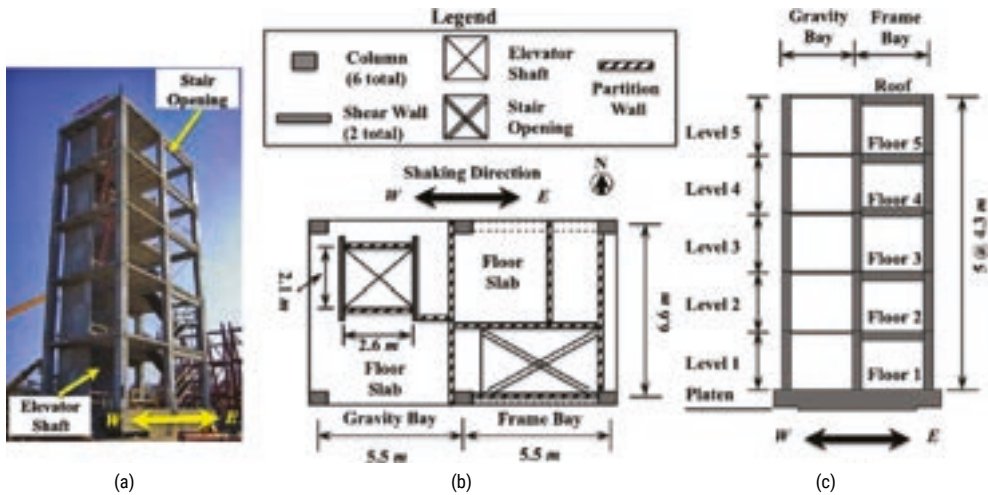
Schema della struttura: (a) foto; (b) pianta del piano 3; (c) vista in elevazione (non sono mostrate le pareti di taglio) [Wang, 2017].
